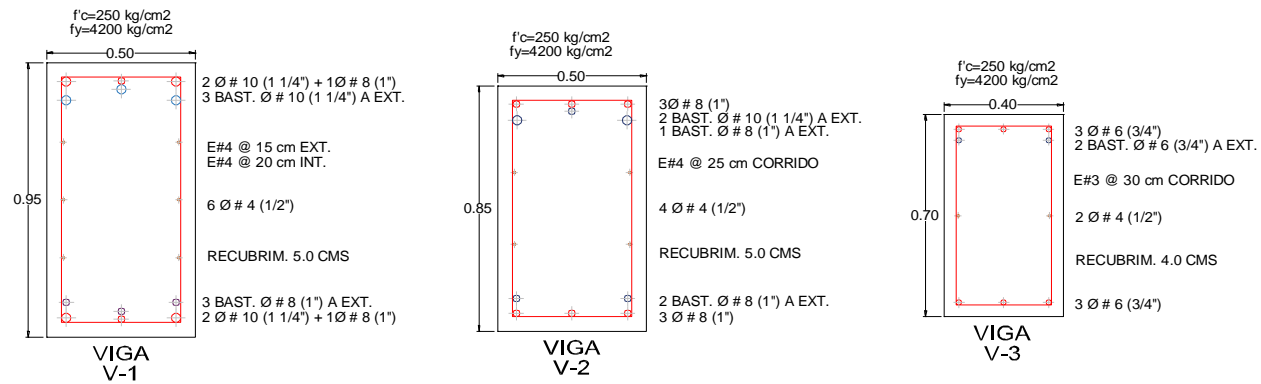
Detallado de armado de vigas del marco de 12 niveles con base a la hipótesis de las NTCC-17.
